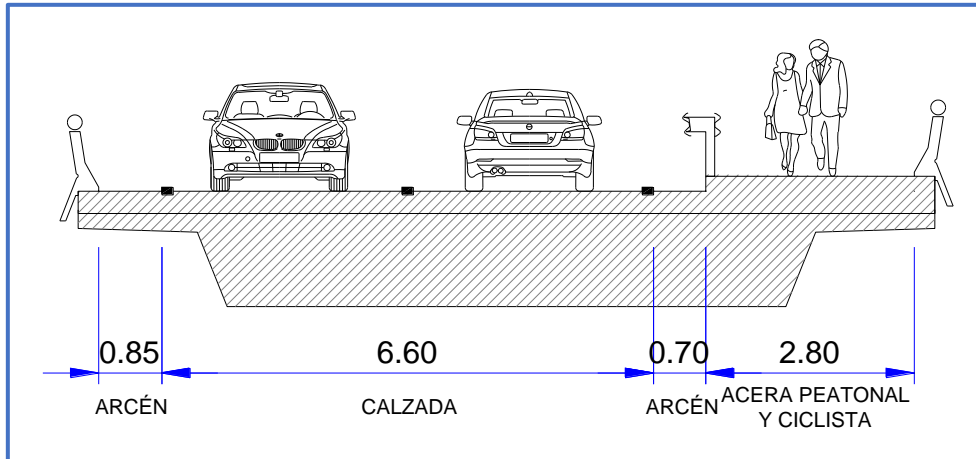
sección transversal existente en viaducto sobre A-15.
